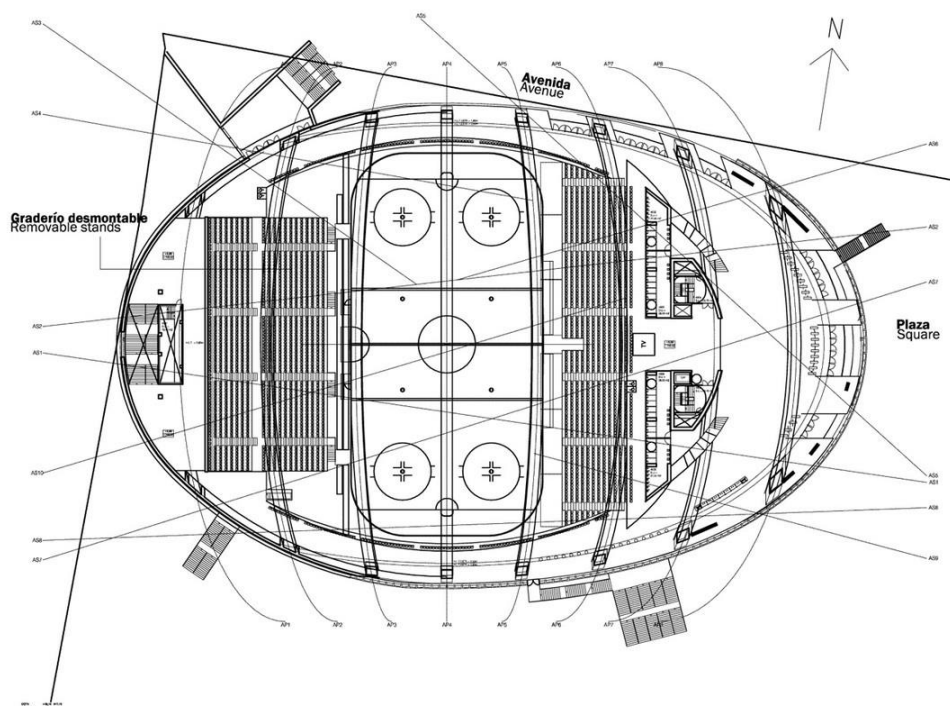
План поверху, арх. Coll-Barreu Arquitectos: Coll-Barreu Arquitectos – Juan Coll-Barreu & Daniel Gutiérrez Zarza [4]
